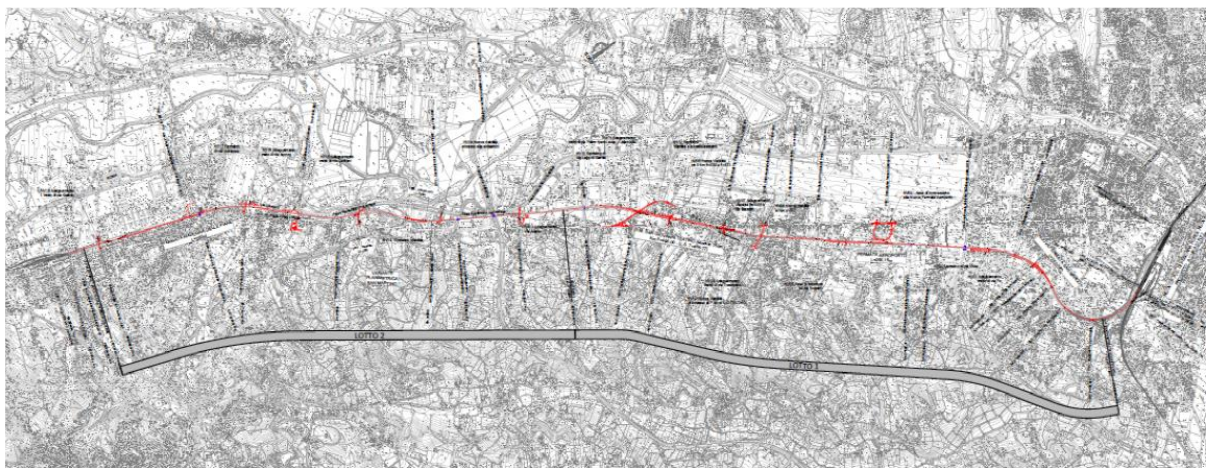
Planimetria Pescara-Chieti Lotto1 -Lotto2 (Fonte: RFI, luglio 2020)
